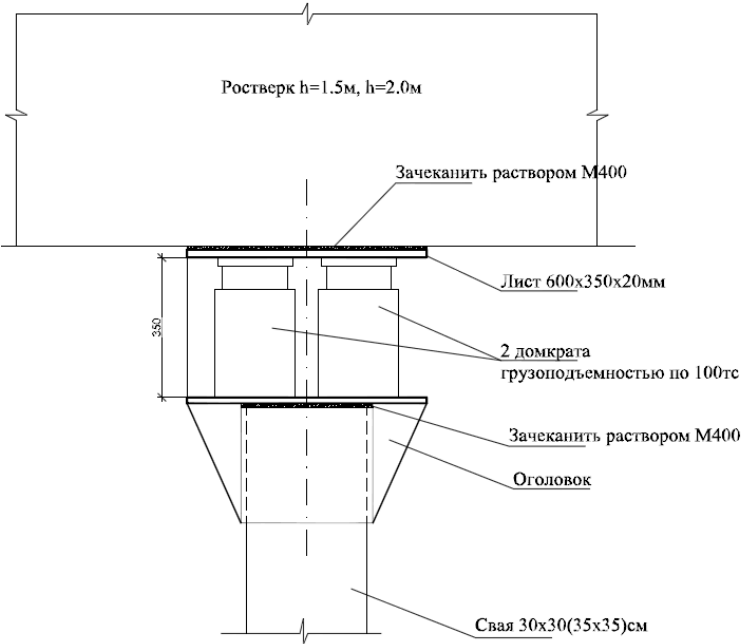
Эскиз узла по размещению домкратов для испытания грунтов сваями
